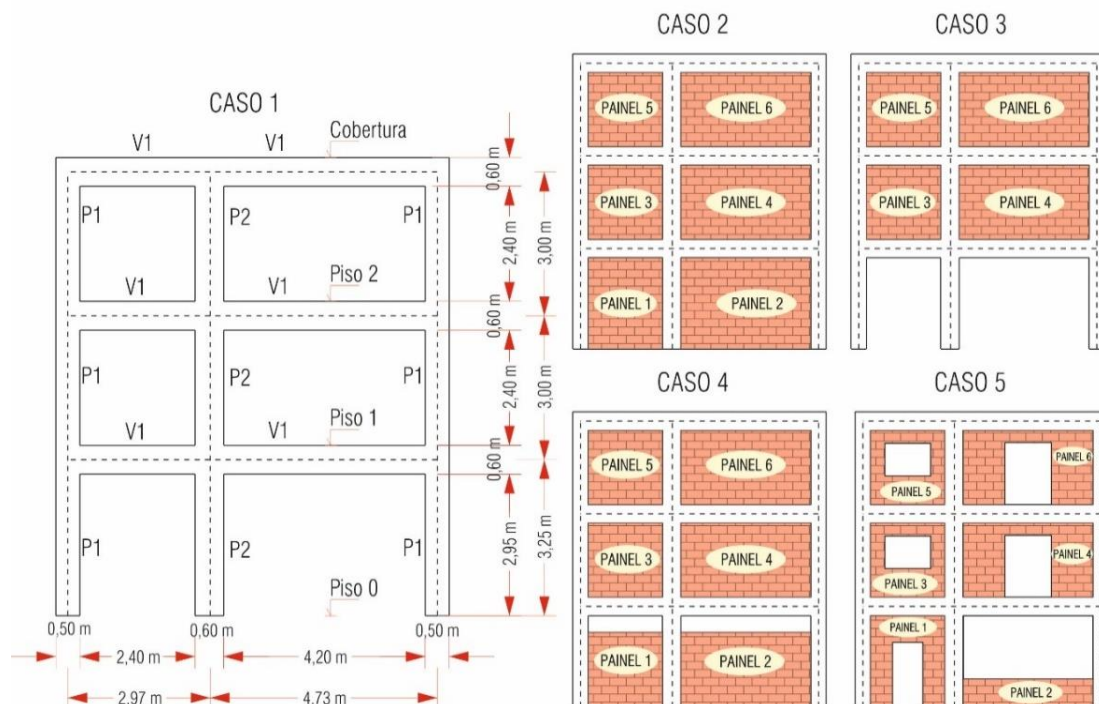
Casos de estudo com pórticos de betão armado e a respetiva numeração dos painéis.
